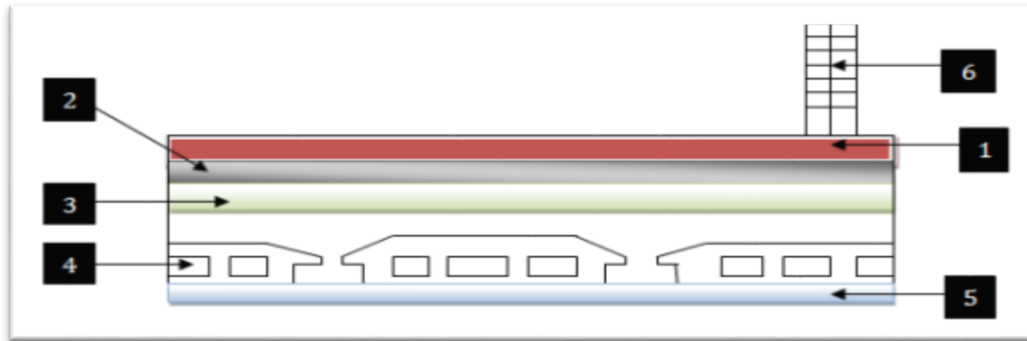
Coupe transversale au niveau de plancher étage courant
